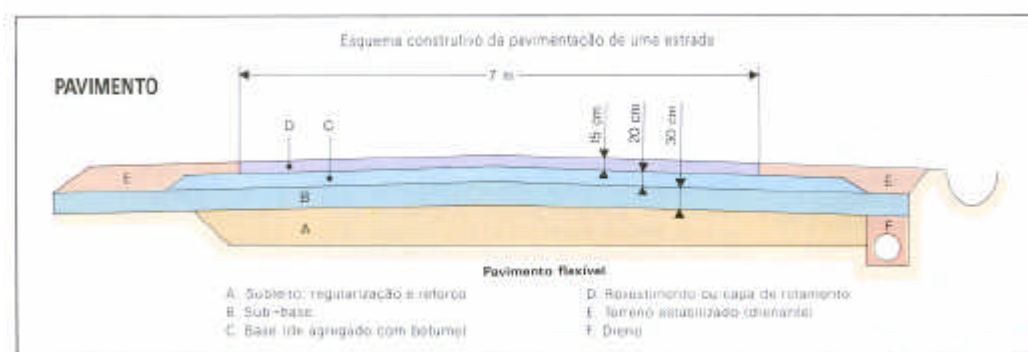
Seção transversal de pavimento típico (detalhe de suas possíveis divisões; parte: D, revestimento). Fonte: Larousse, 1995.
